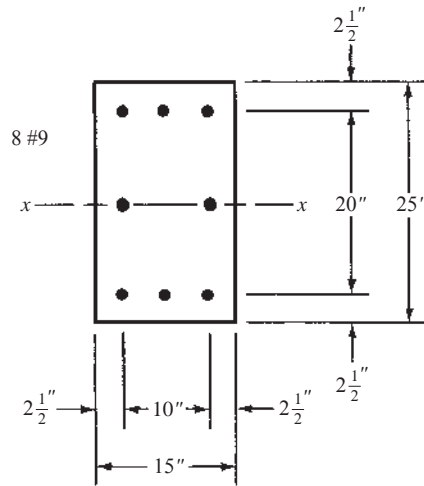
Sección transversal de la columna del Ejemplo 10.8.
